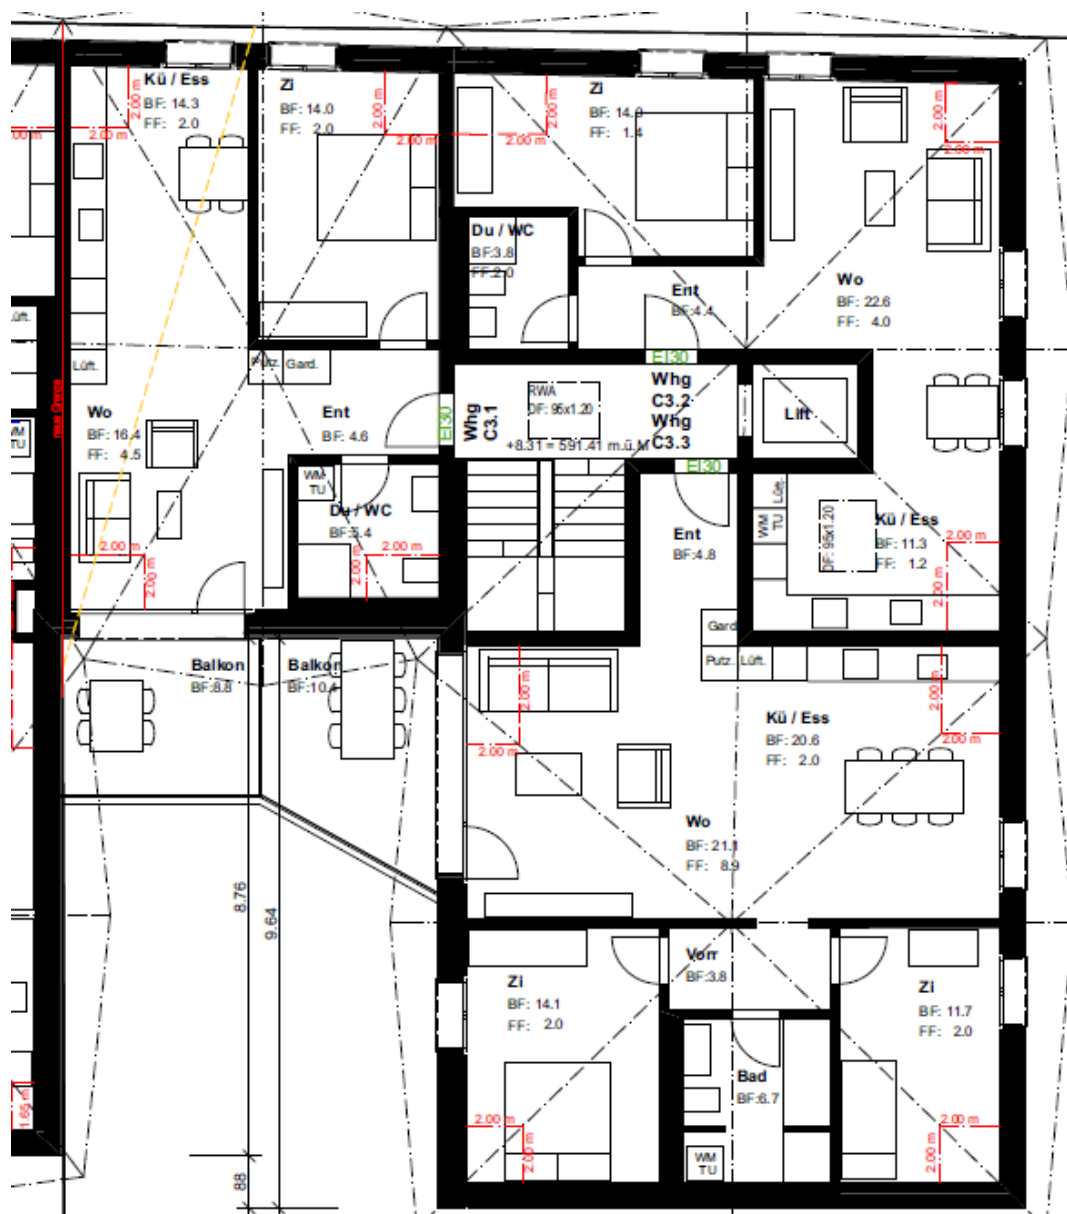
Grundriss Dachgeschoss, eigenes Projekt
